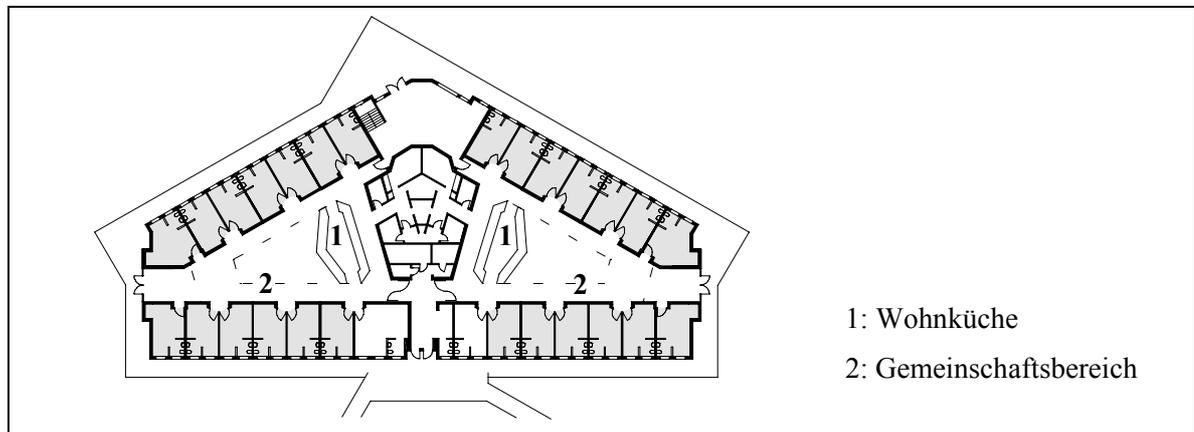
Grundriss des Corinne Dolan Alzheimer Center at Heather Hill, Chardon, OH (USA)¹⁵²
